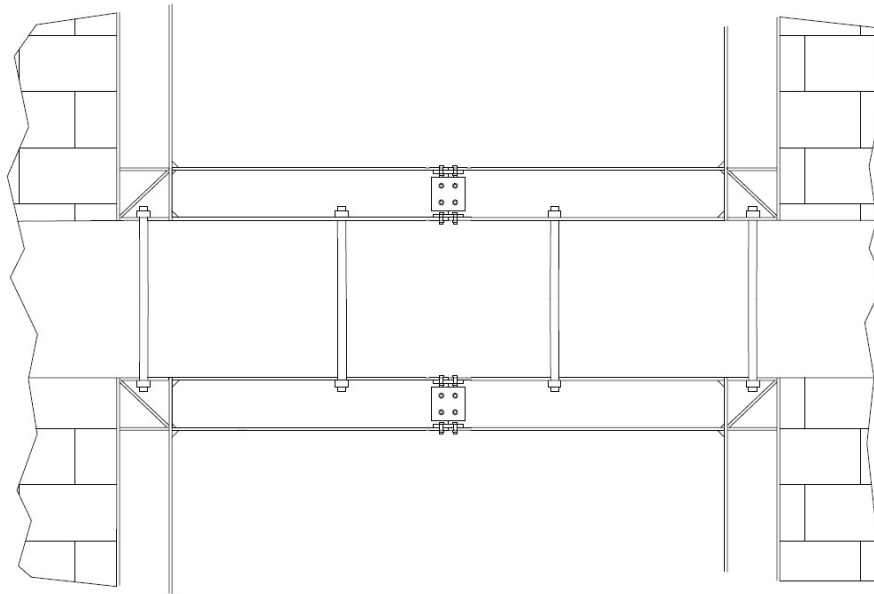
Particolare, collegamento di telai sovrapposti.
